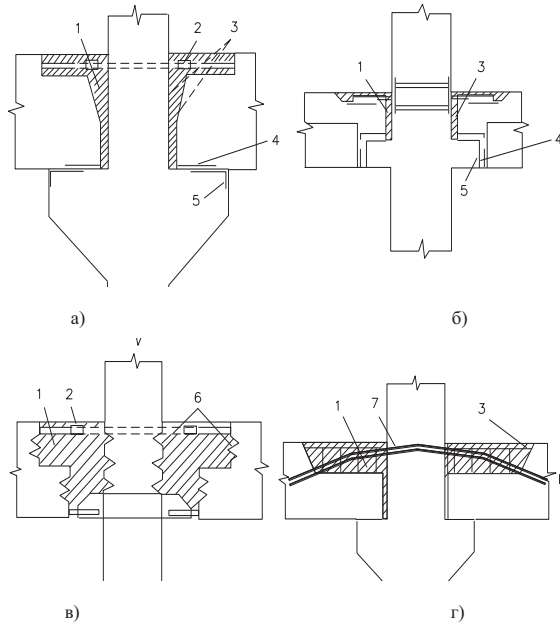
Стики ригелів з колонами: а) – жорсткий; б) – з прихованими консолями; в) – консольний з шпонками; г) – з напружуваною арматурою; 1 – бетон замонолічування; 2 – ванне зварювання; 3...5 – контакти відповідно: бетон-контактний шар-бетон; метал-метал; метал-бетон; 6 – шпоночний шов; 7 – напружена опорна арматура
